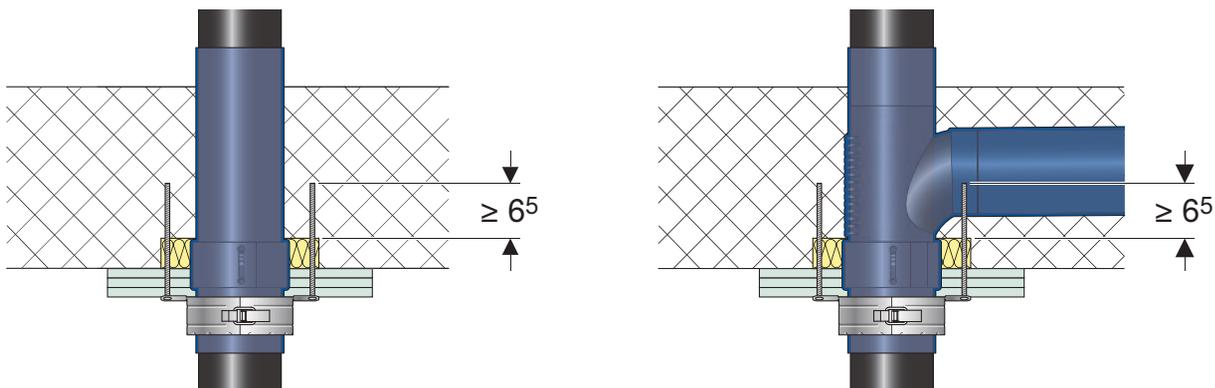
Traversée de dalle supérieure avec protection de coffrage et manchon électro-soudable
